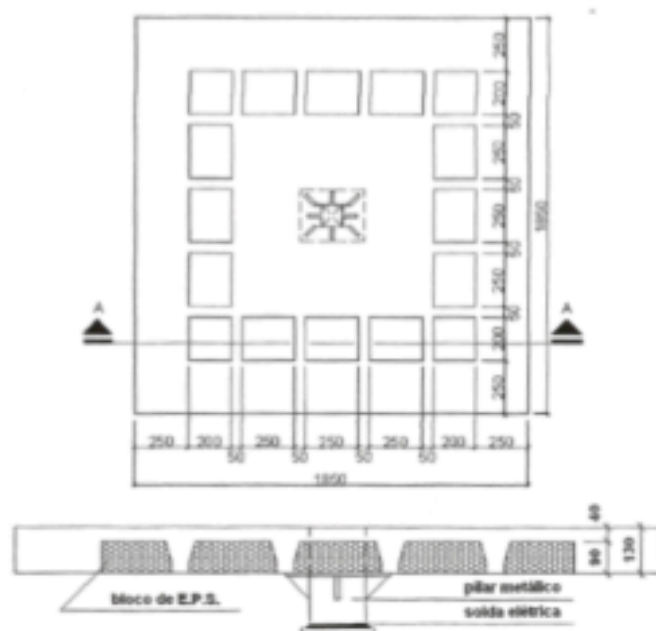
Planta baixa e corte A-A típicos das lajes ensaiadas (medidas em mm)
